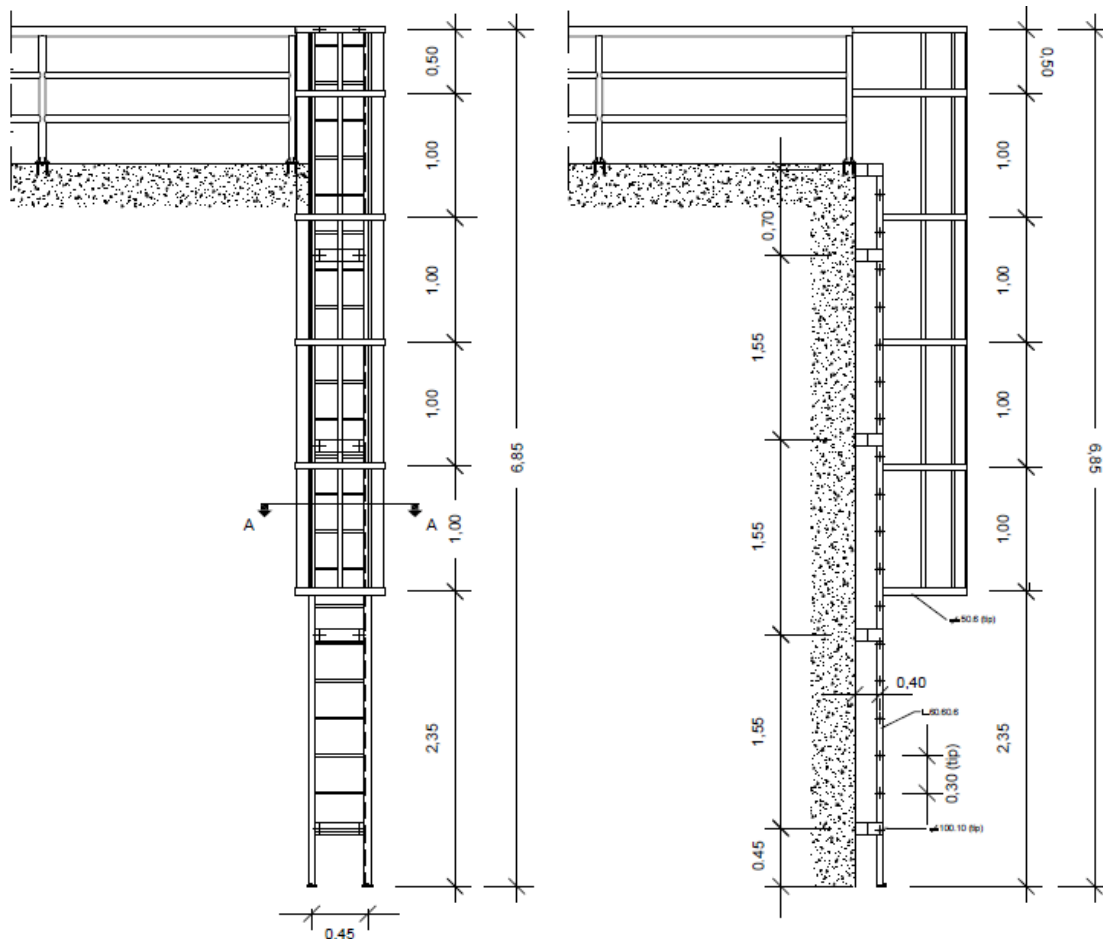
Vista en alzado y perfil de la escalera de gato proyectada (mediciones).
